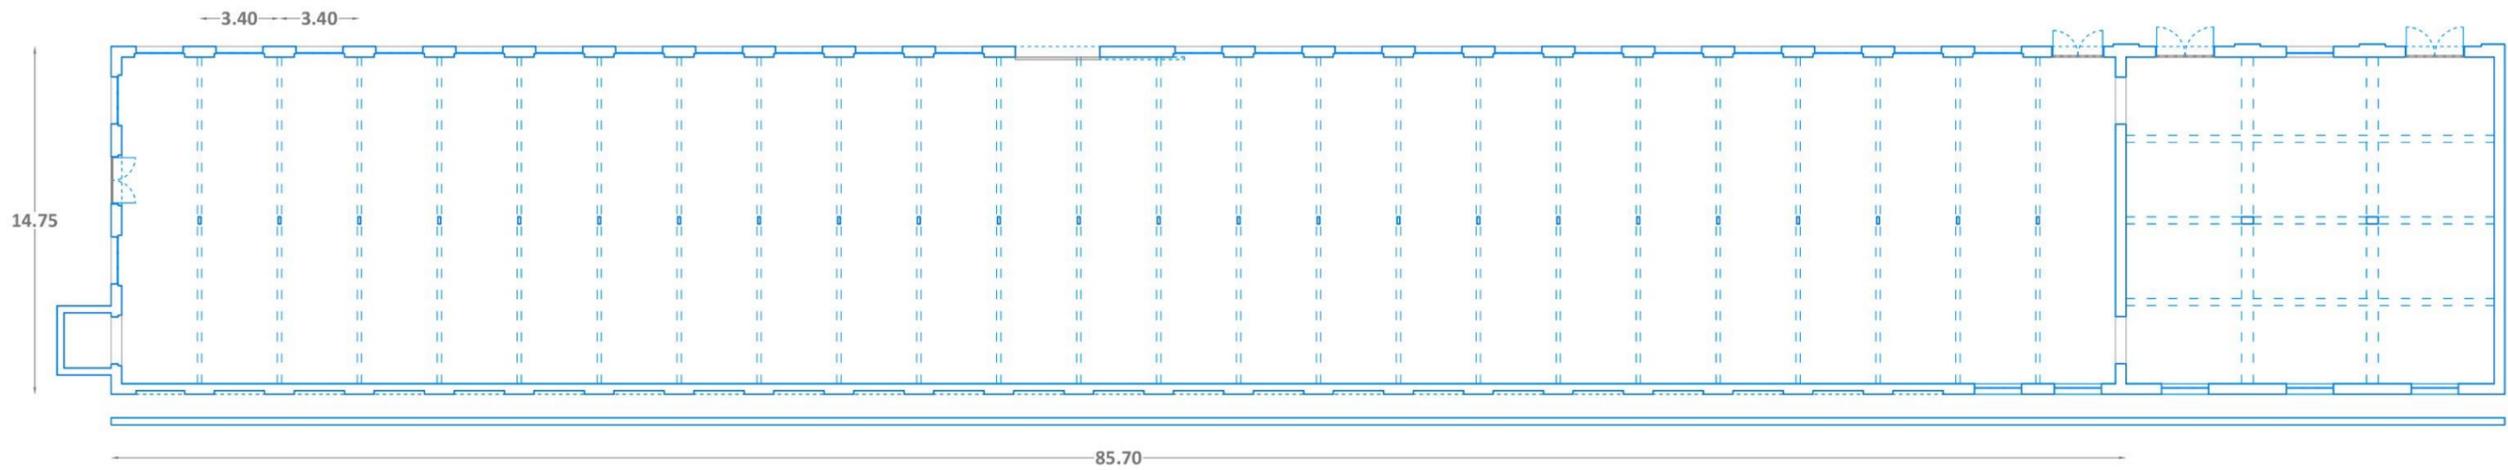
PLANO 1/300. Planta baja pre intervención nave G original fábrica Fabra i Coats.
